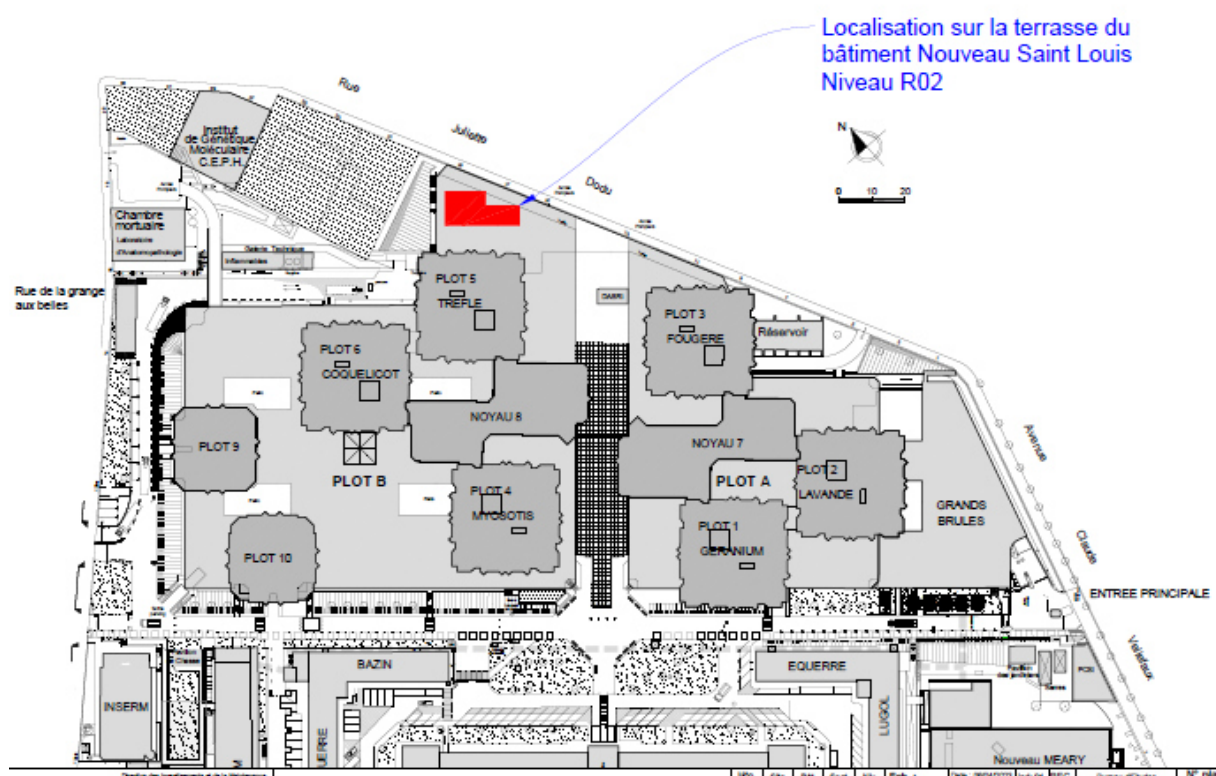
Extrait du plan de masse de l'hôpital Saint-Louis, implantation de la construction modulaire
